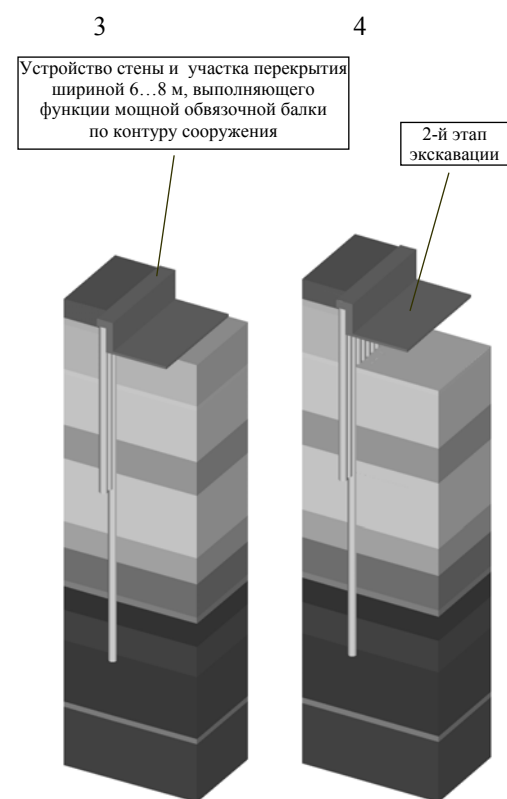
Возможная последовательность работ по устройству подземного сооружения. Для подземного сооружения круглого в плане устройство участков перекрытий не требуется
